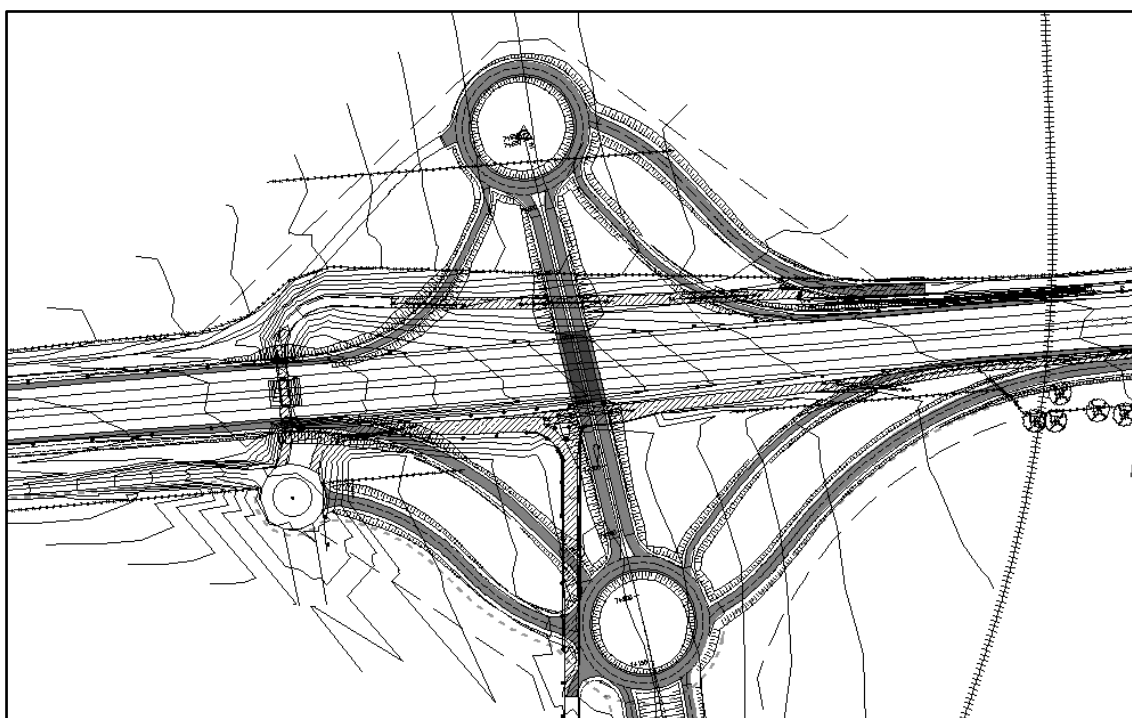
Planta del plano de proyecto vial de la intersección Ruta 20 – Boulevard Enlace.
